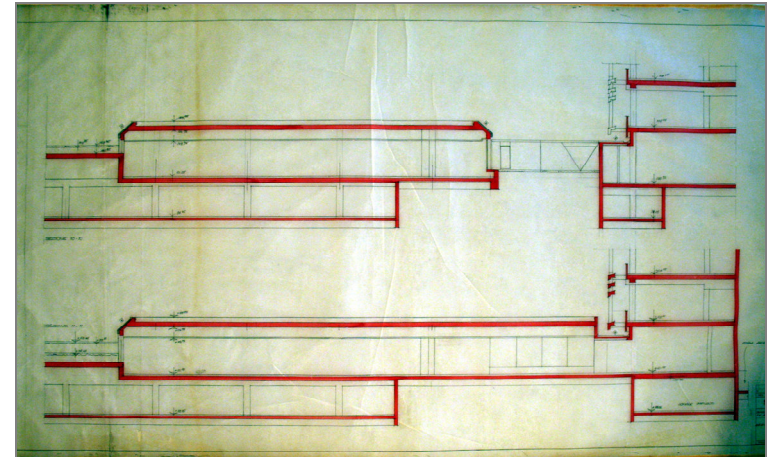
sezione del volume interno al cortile (fonte CSAC – stralcio tav. 52, archivio n. 384-5)
